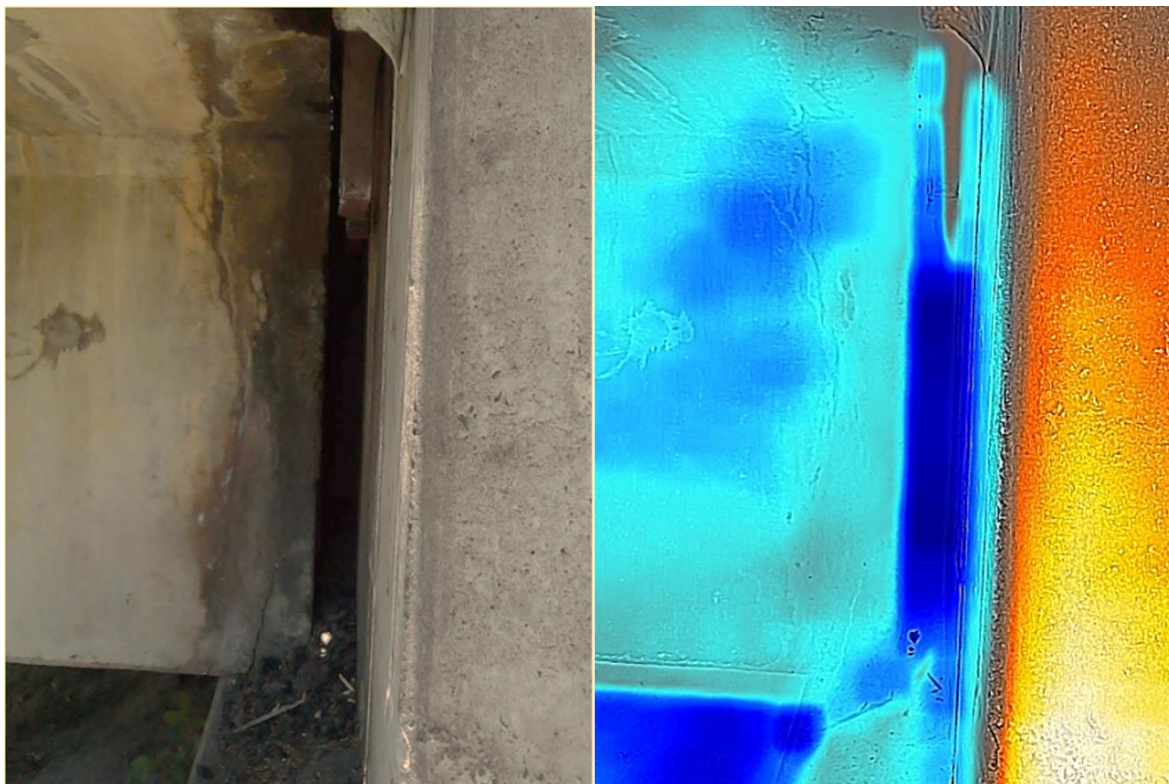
Detalle ampliado de los apoyos en la sección No. 9
